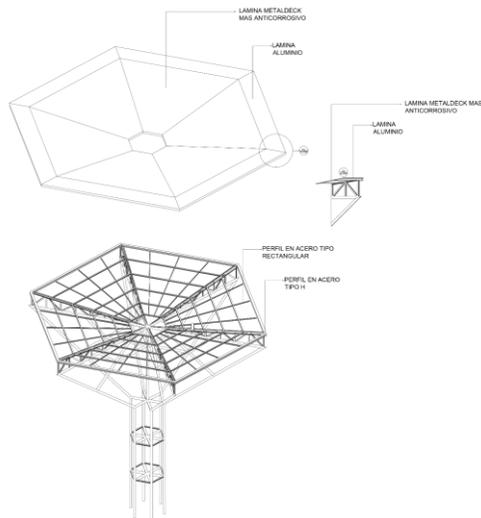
Detalle constructivo cubierta; Fuente: Elaboración propia
